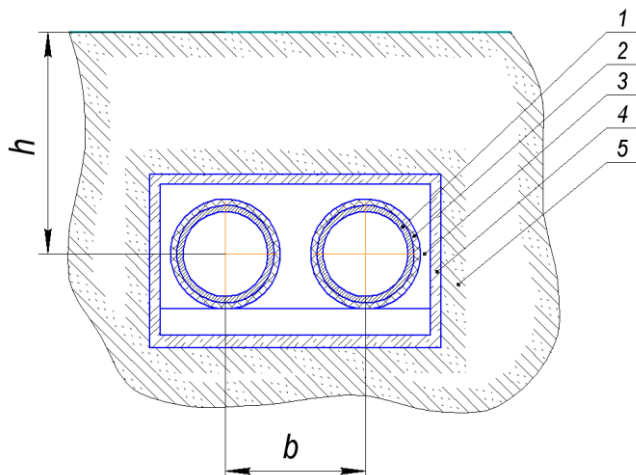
Схема рассматриваемой системы «трубопровод – окружающая среда» (1 – металлическая стенка трубы, 2 – слой тепло- и гидроизоляции, 3 – воздушная прослойка, 4 – железобетонный короб, 5 – грунт, h – расстояние между поверхностью грунта и осью трубопровода, b – расстояние между осями трубопроводов)
